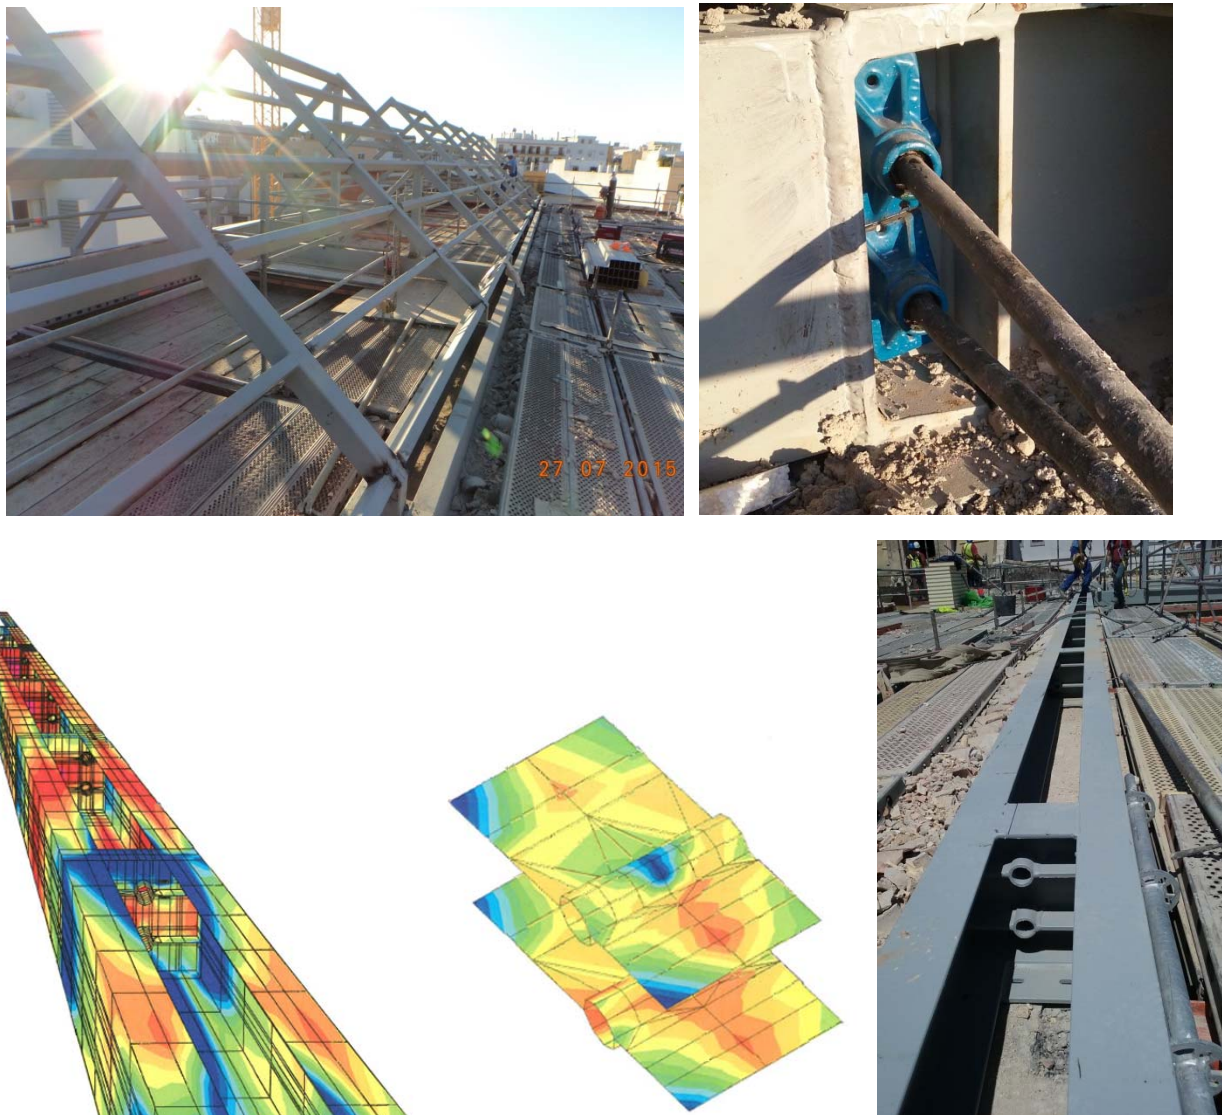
Detalle de cubierta y cajón metálico PT para compensar la transmisión de empujes a muro
